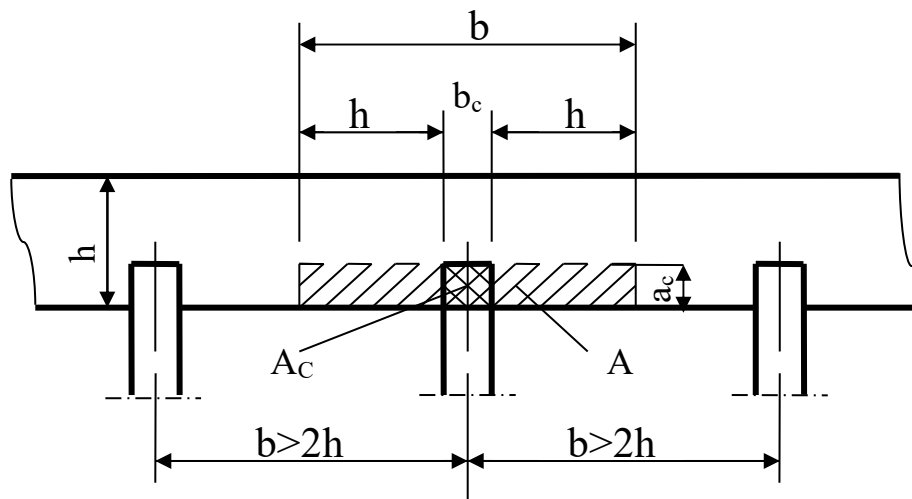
Определение расчетных площадей сечения при местном сжатии (смятии) кладки:
